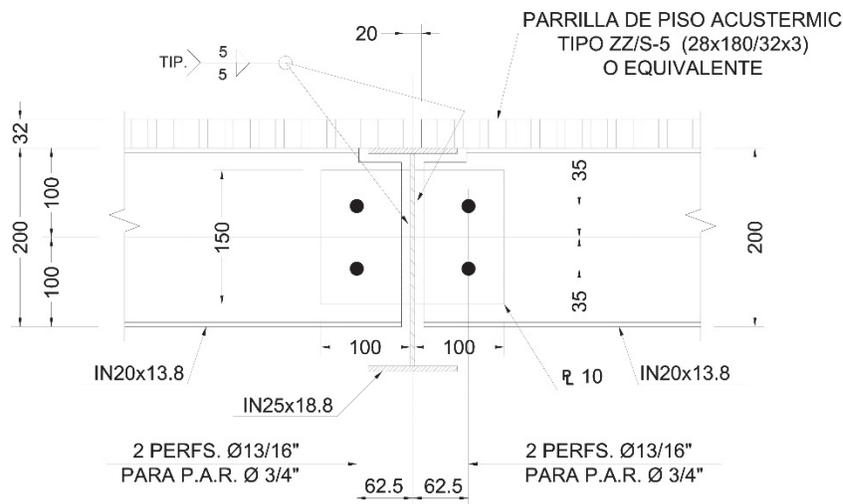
d.- Esquema general de conexión de las vigas principales y secundarias en la cubierta de los PVF.
